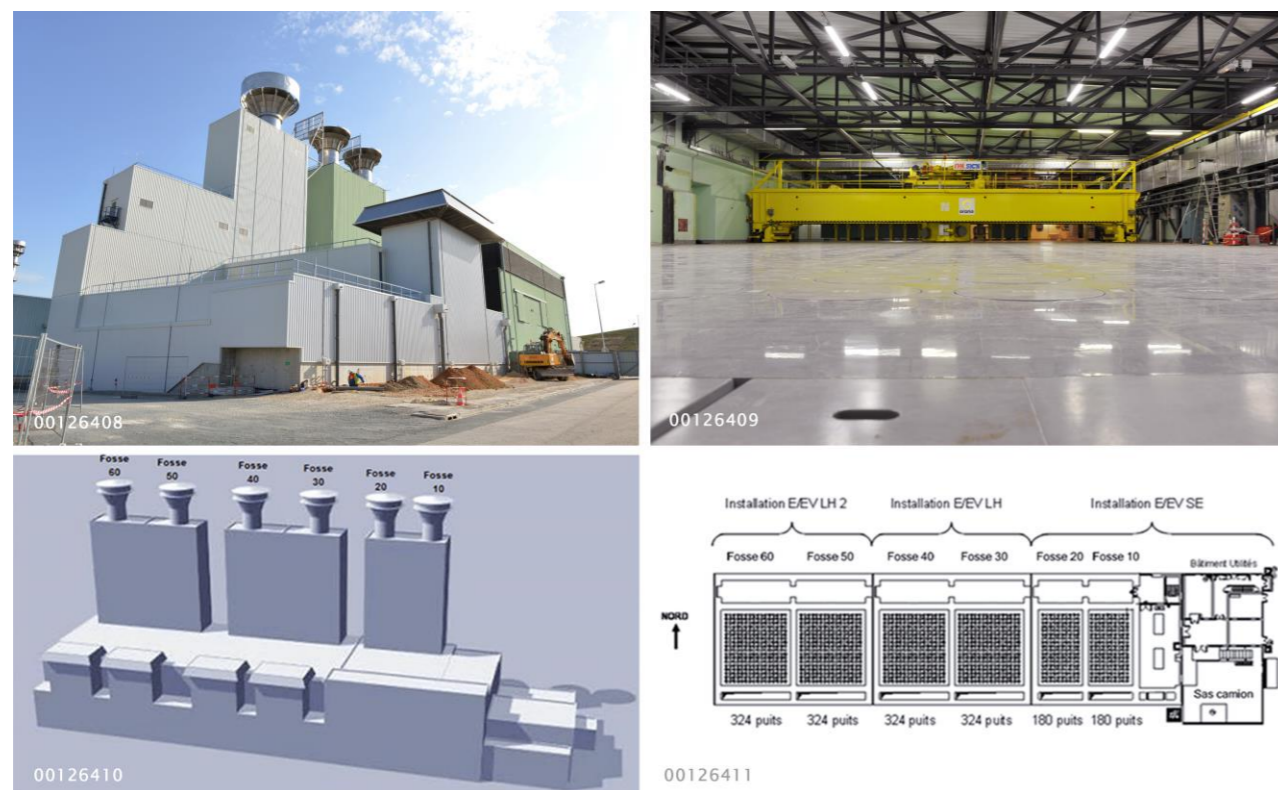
Exemple d'installation d'entreposage de déchets HA : installation E-EV-SE du site Orano de La Hague (source : Orano)
